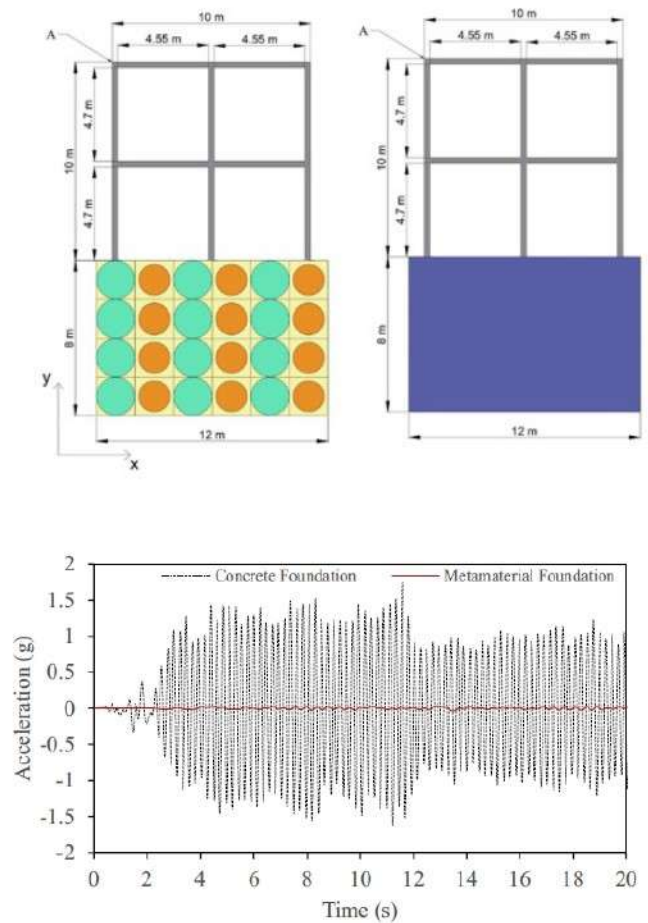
Dall'alto in basso: (a) struttura in acciaio su fondazione in metamateriale; (b) struttura in acciaio su fondazione in calcestruzzo; (c) risposte nel tempo delle due strutture, nel punto A, al terremoto della Imperial Valley (1940): curva nera tratteggiata per la fondazione in calcestruzzo, curva rossa continua per la fondazione in metamateriale. Da [14].
